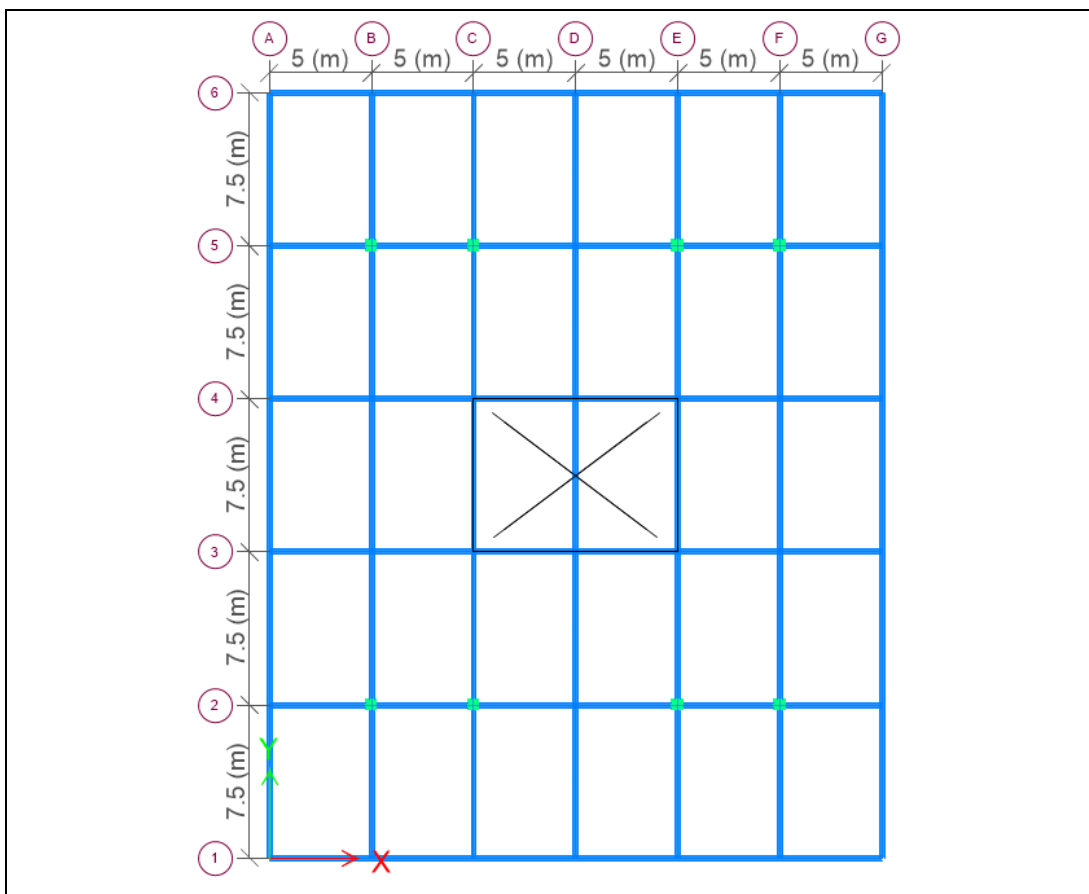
Estructuración Planta Típica del Sistema Diagrid Modelo A
